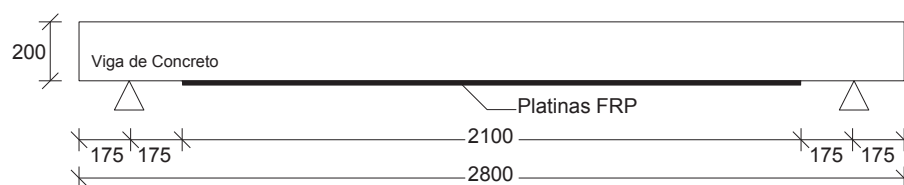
Vigas de concreto con platinas y/o láminas FRP adheridas para ensayo a flexión purasometidas a carga última.
